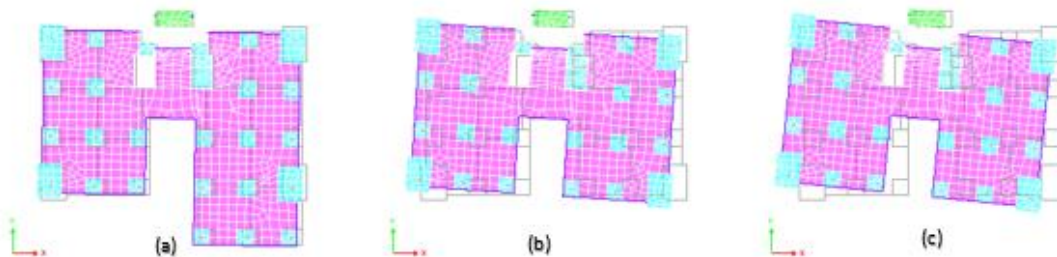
Vista en planta del modo de vibración 1 correspondiente al Caso 6. a) Segunda Planta. b) Quinta Planta. c) Octava Planta.
